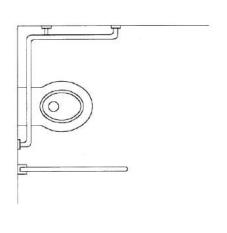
Barras de apoyo. Tipos. (Dimensiones en mm)
